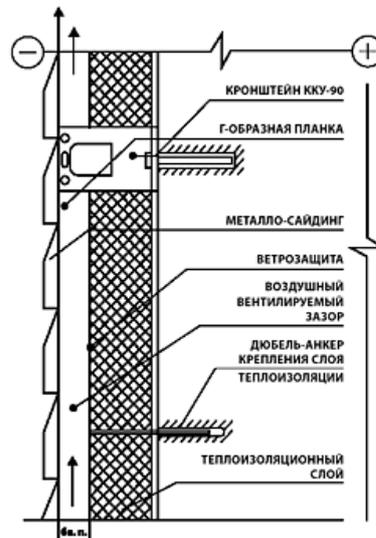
Устройство вентилируемых наружных стен в зданиях и сооружениях
